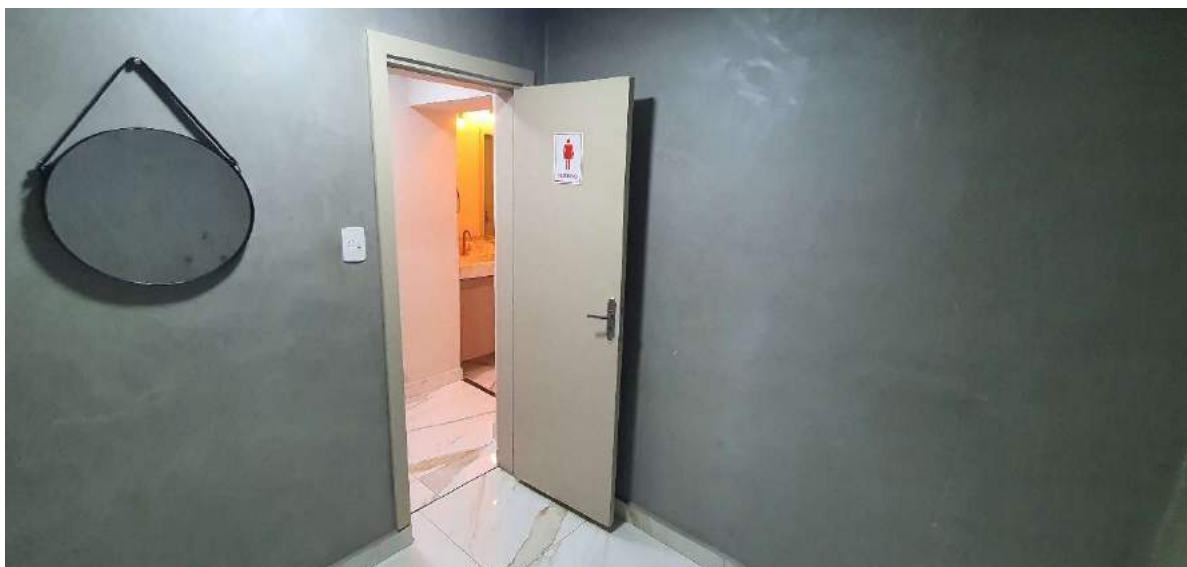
BANHEIRO PARA DEFICIENTES, VISTA OPOSTA.
